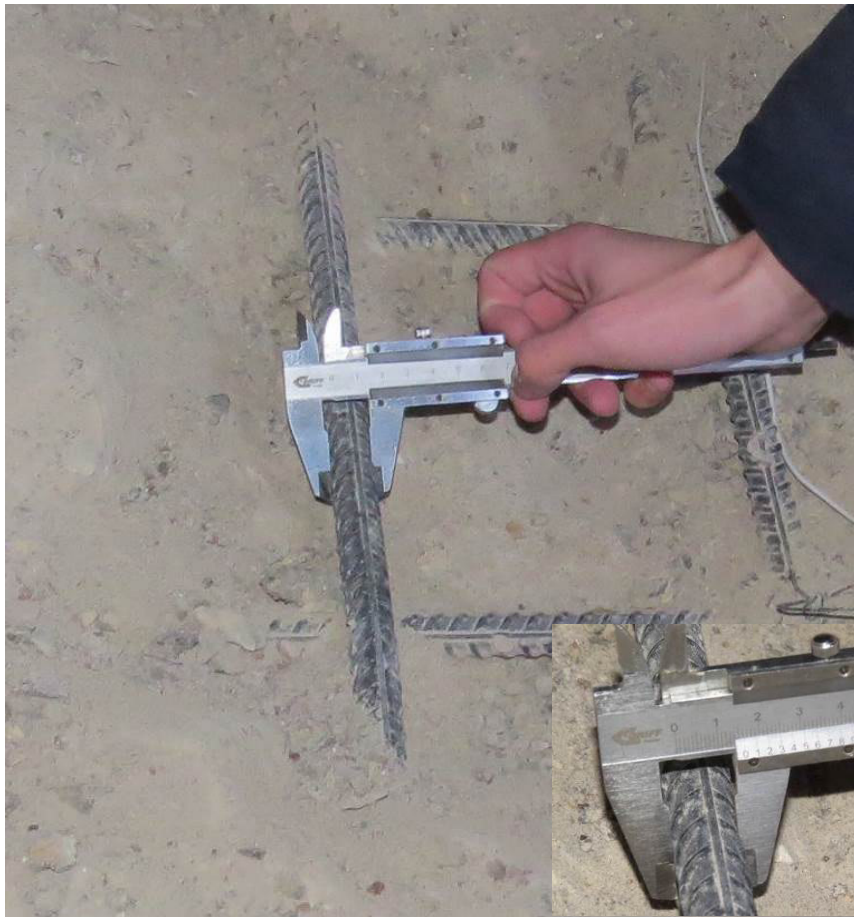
Определение диаметра (16 мм) арматуры верхней зоны армирования фундаментной плиты на участке вскрытия в секции 3 между осями А-Б, 23-24
